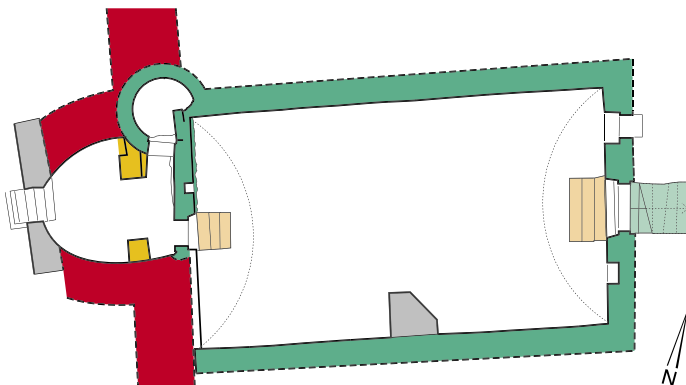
Büren a. A., Kreuzgasse 20. Grundriss des Kellergeschosses. M 1:200.
